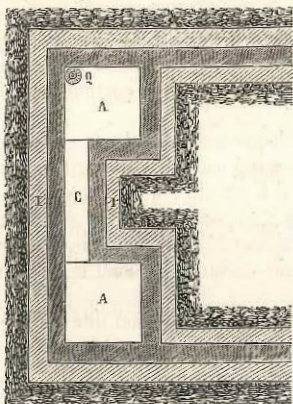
Plan du fond de la fumière de M. Boussingault.
